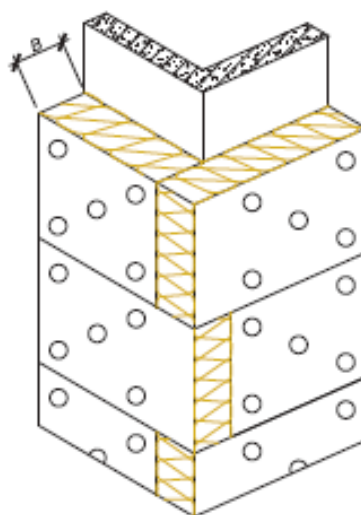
Схема укладки и крепления плит утеплителя в один слой на угол здания
